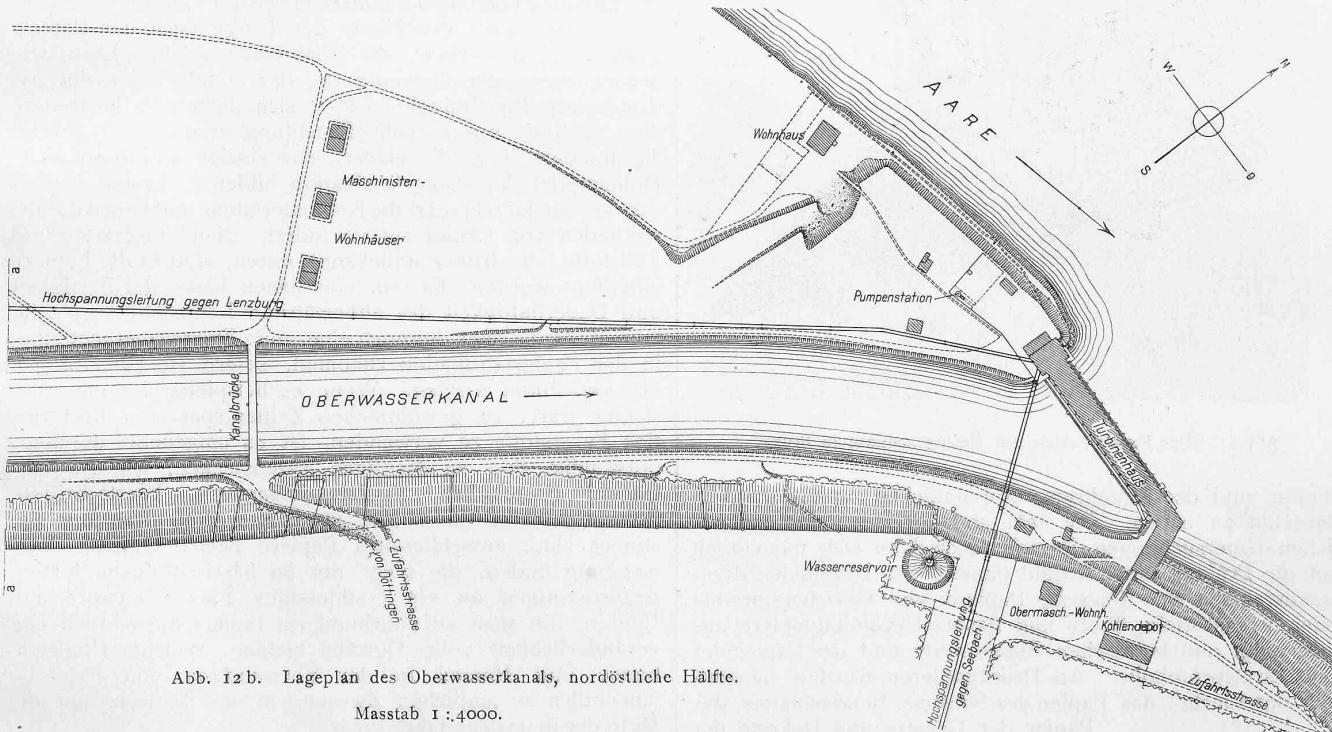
Lageplan des Oberwasserkanals, nordöstliche Hälfte.
